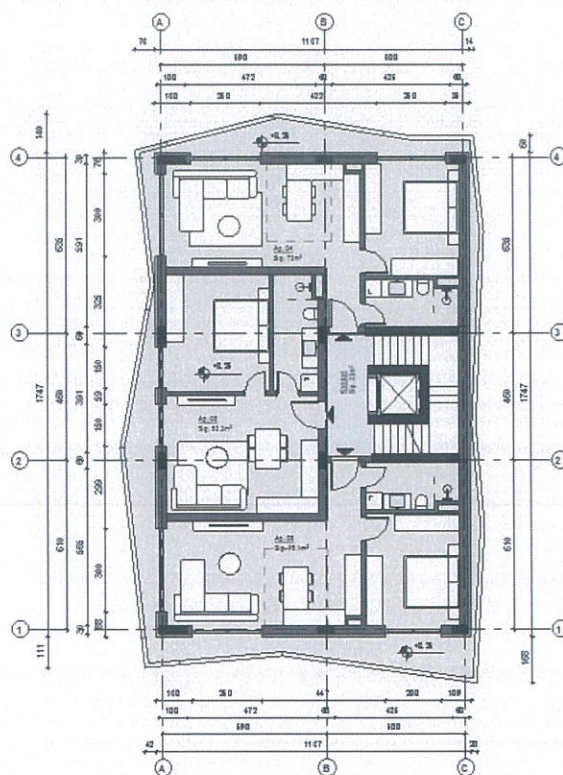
Planimetria e katit +2 me sipërfaqe 240.6 m² (banim)
